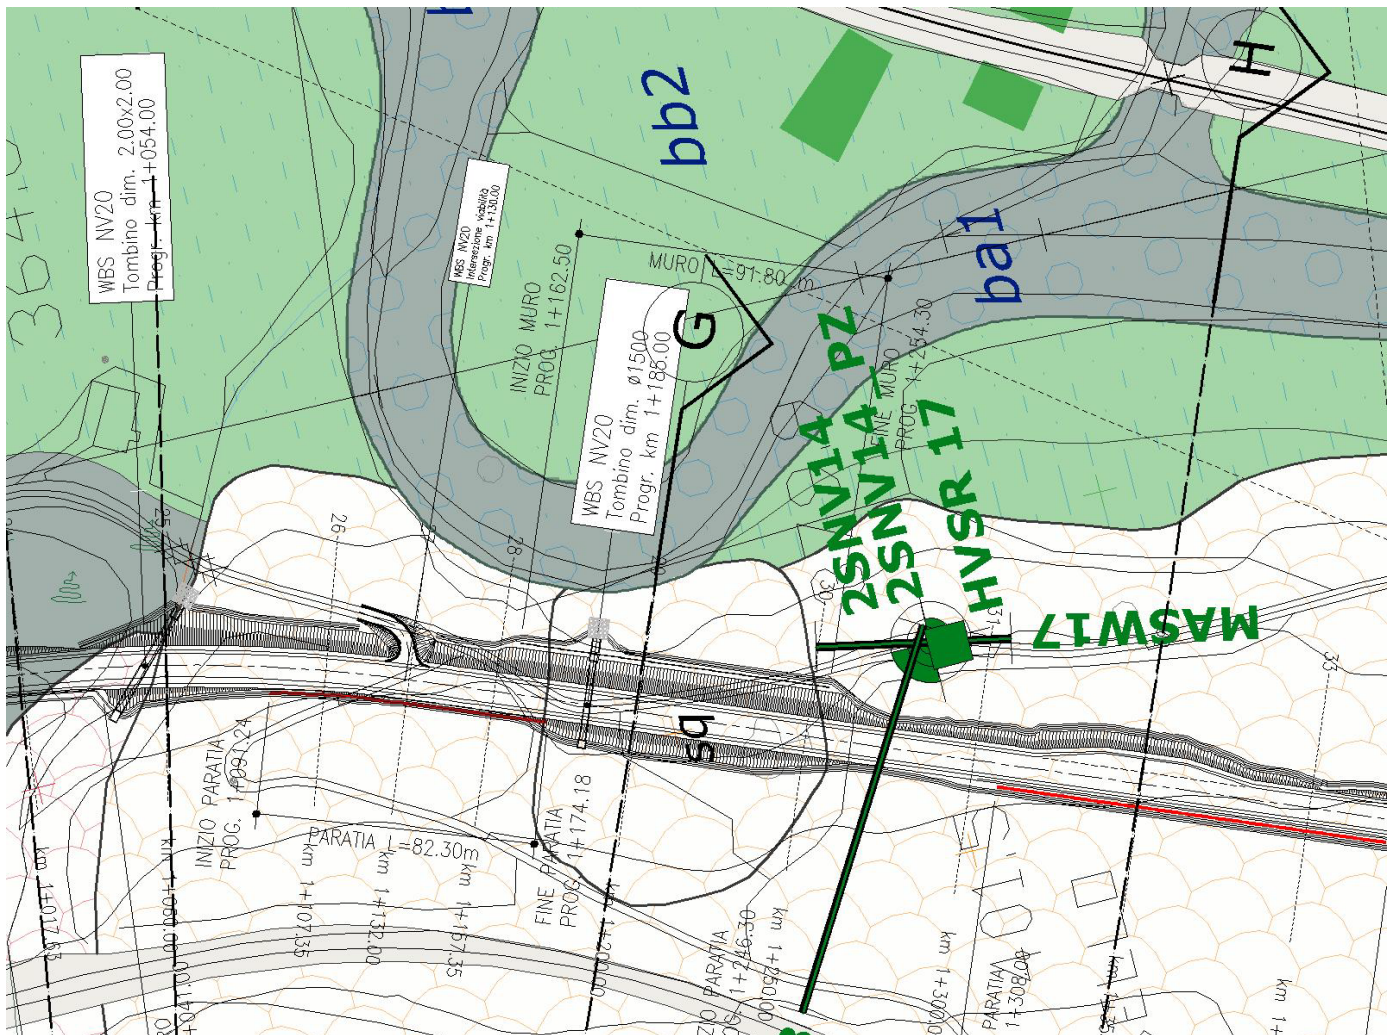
STRALCIO PLANIMETRICO DELL'OPERA IN PROGETTO
